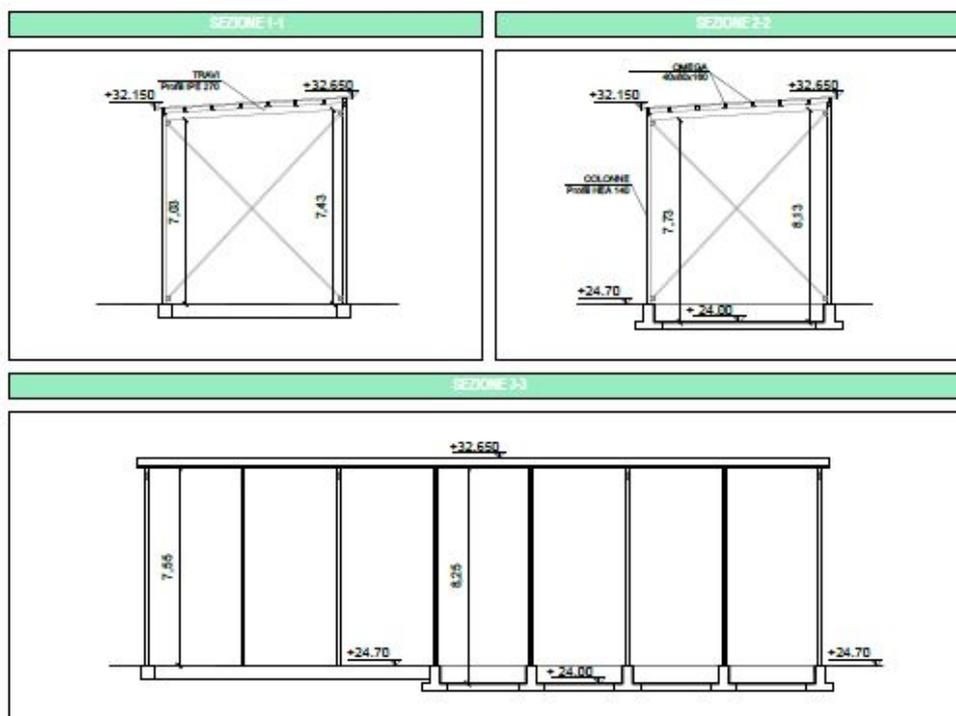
Sezioni trasversali e sezione longitudinale tettoia cisterne e piazzola di lavaggio
